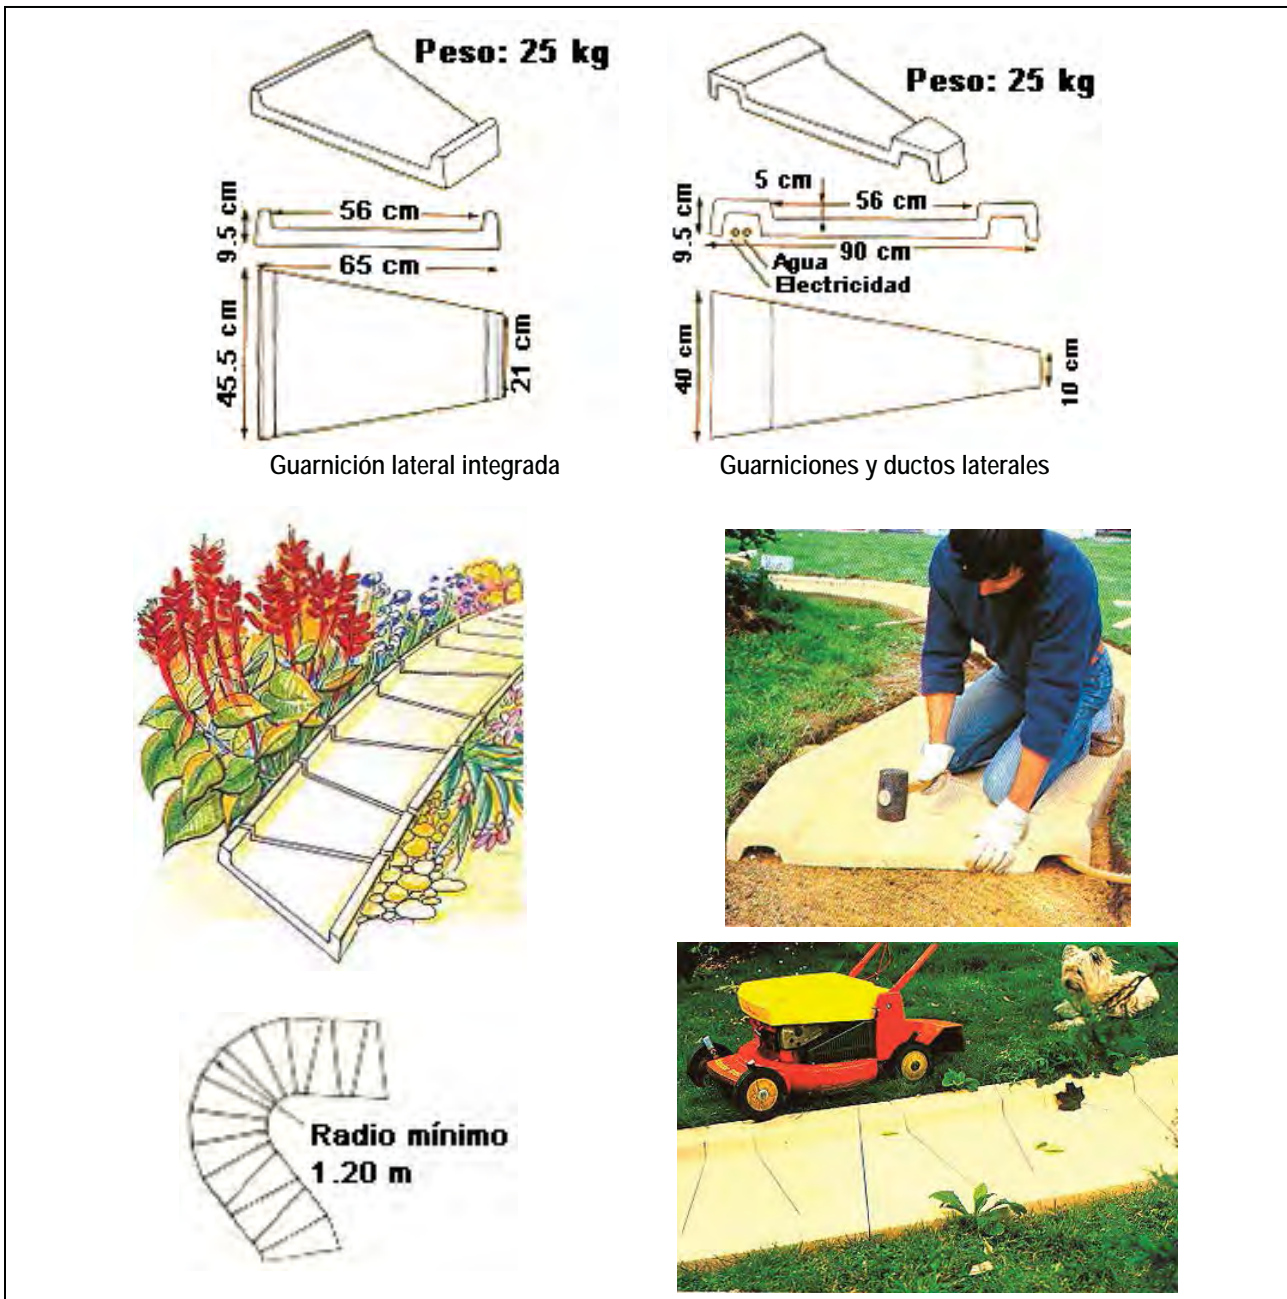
LOSETAS TRAPEZOIDALES PARA ANDADORES EN ÁREAS EXTERIORES
